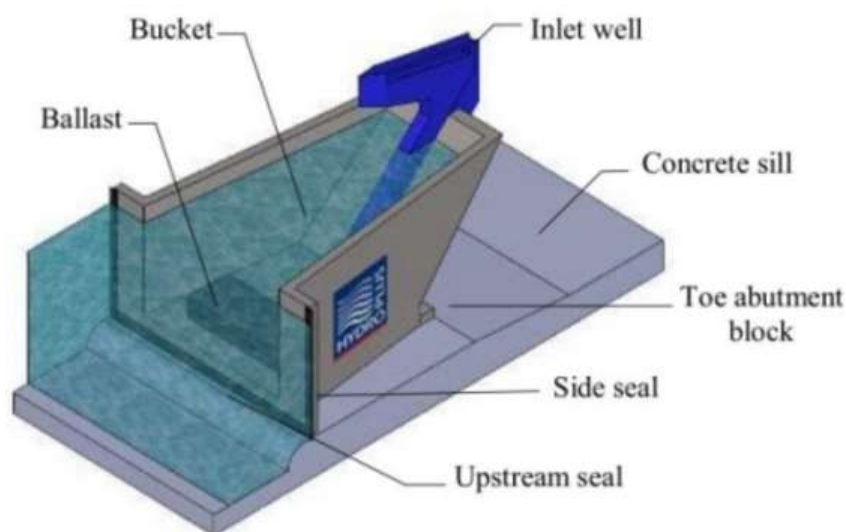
Ausspülbarer Damm aus Stahlelementen; Die Stahlelemente werden auf einer Betonsohle wasserdicht installiert. (Hydroplus, 2016)
